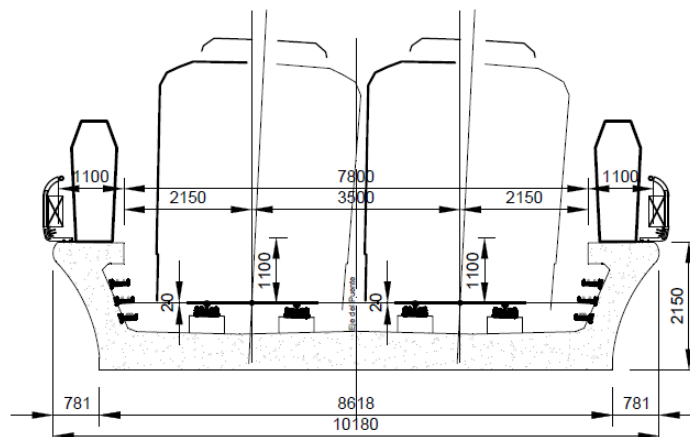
Perfil transversal (Sección en radios 2500 m < R < 3000 m)
